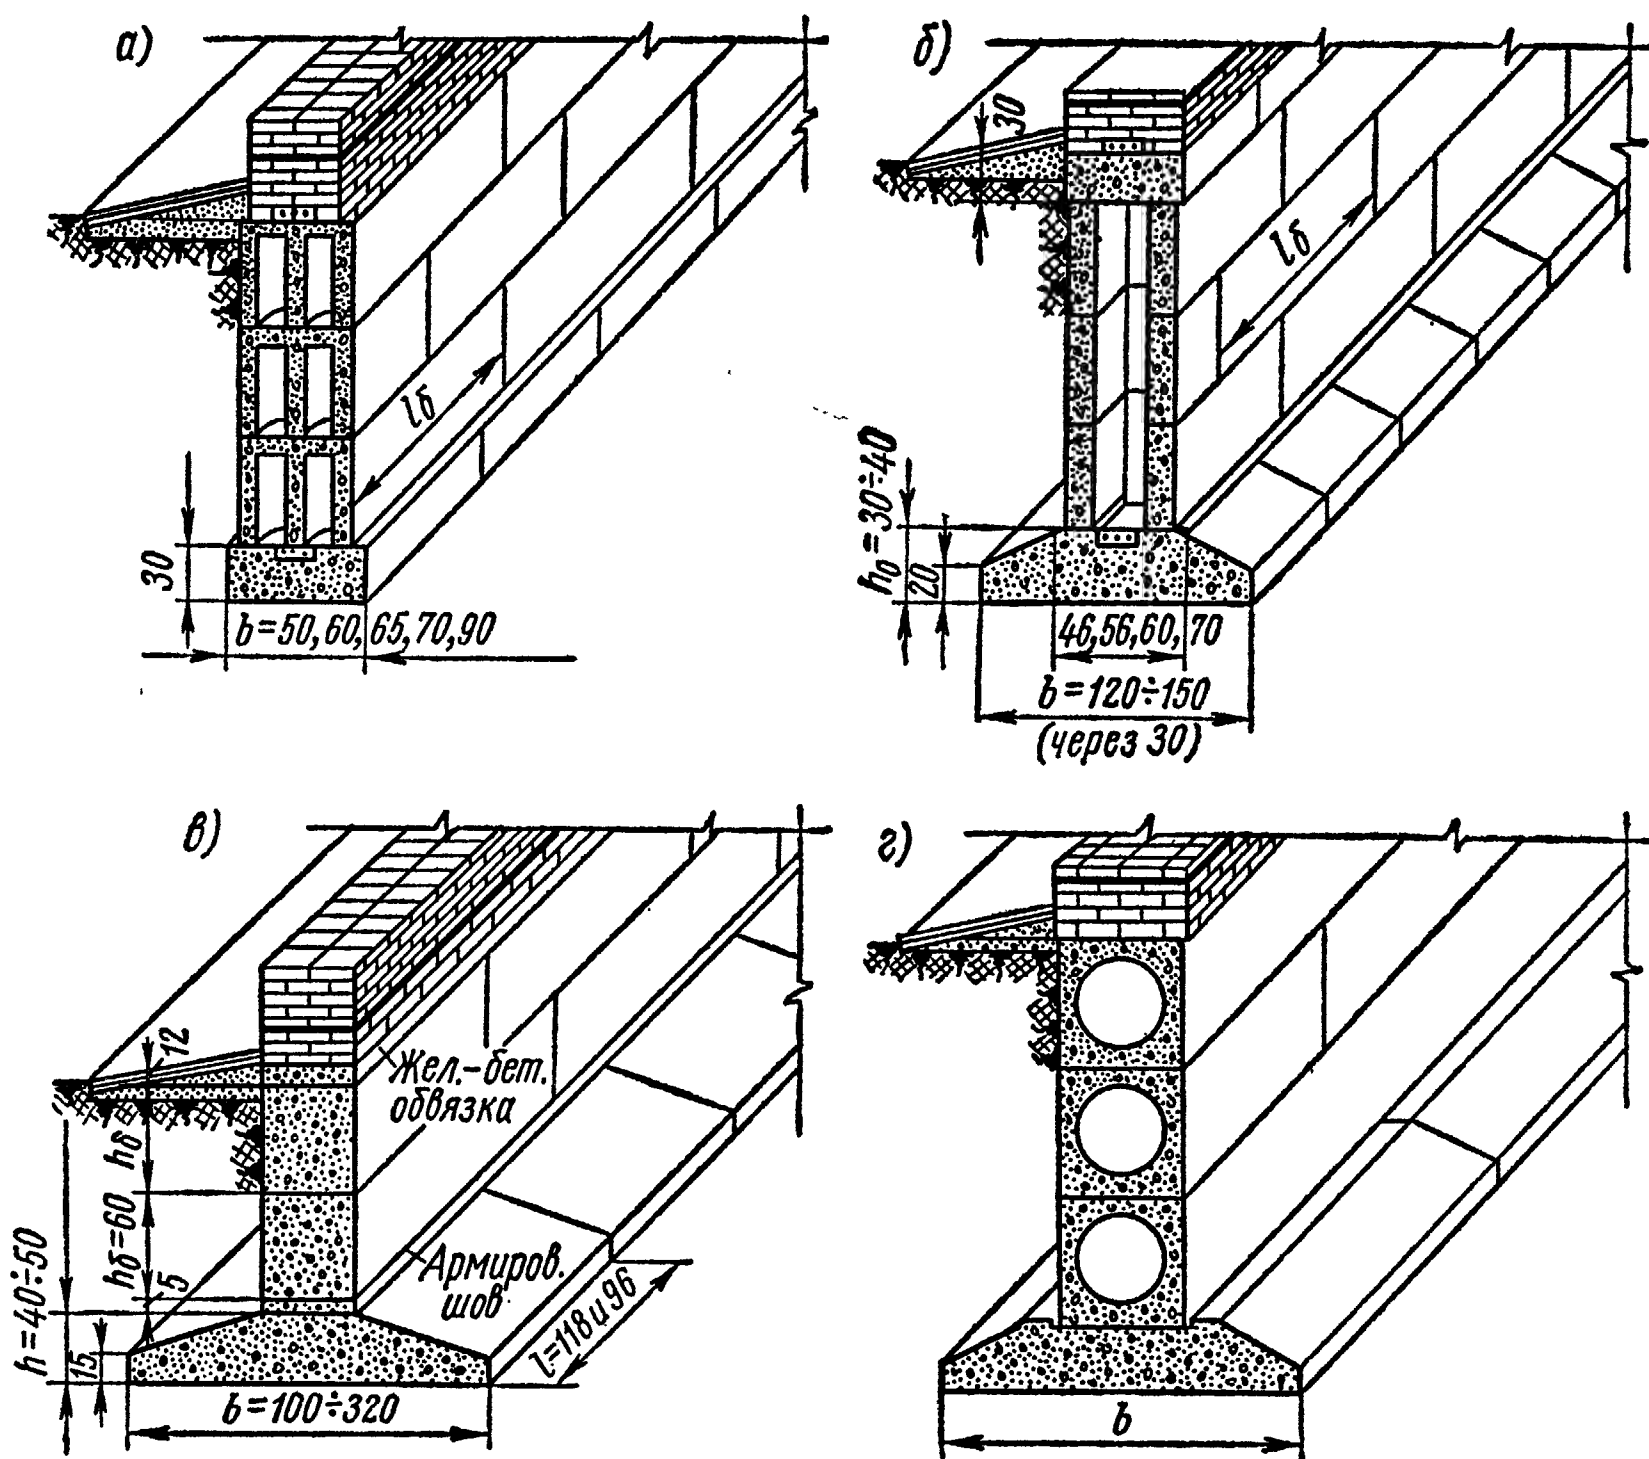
Примеры конструкций сборных фундаментов с подвалом
